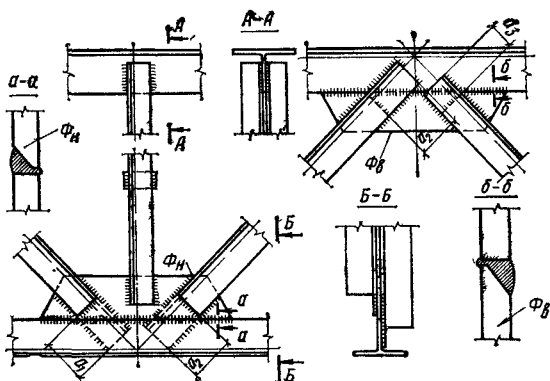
Узлы стропильной фермы с решеткой из парных уголков
